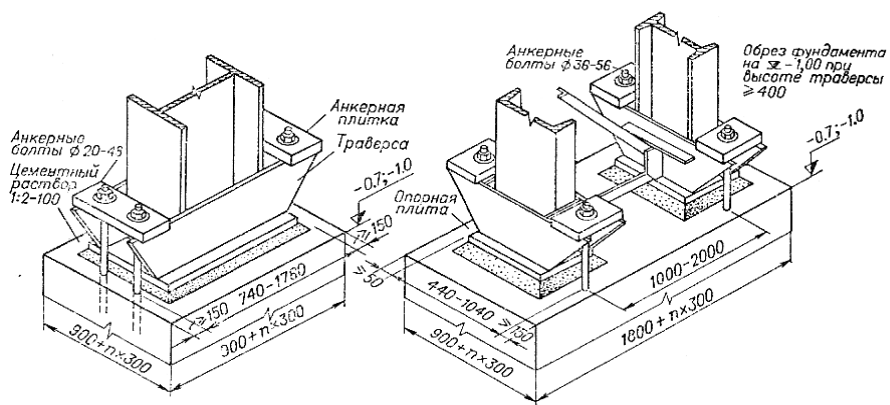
Базы под стальные колонны бескрановых зданий
